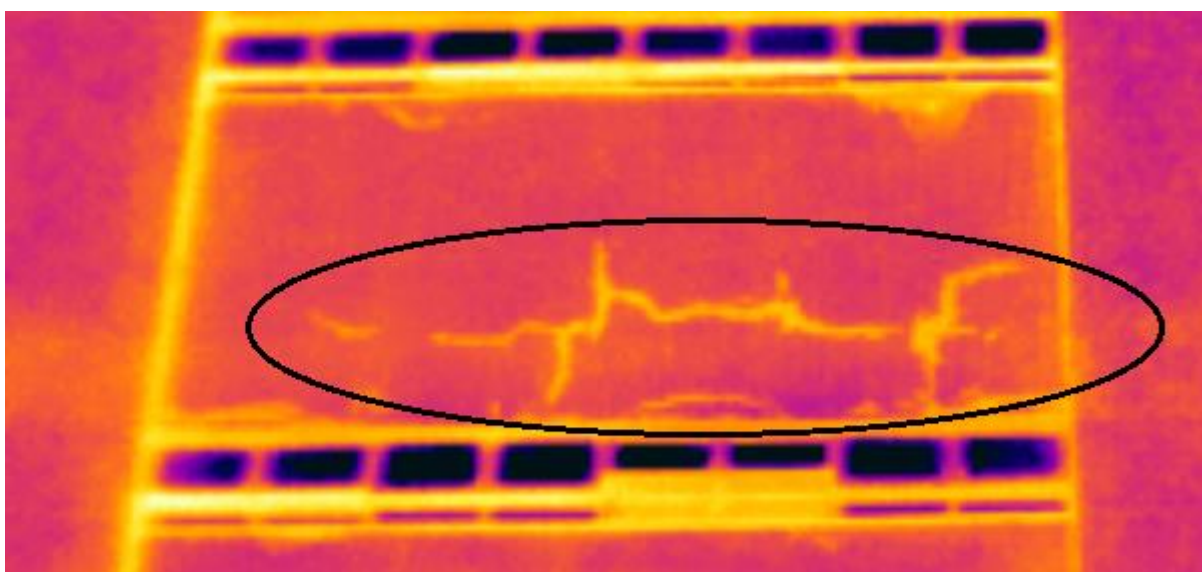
Exemplo de fissura detectado com uso de termografia (Região C2 – Fachada Norte – Edifício A).
